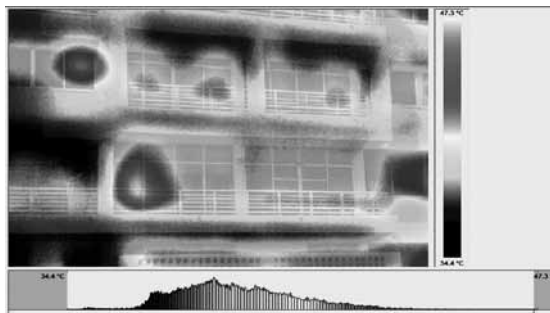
Fachada sur expuesta y sin tratamiento de muros a las 2:30 p. m.
